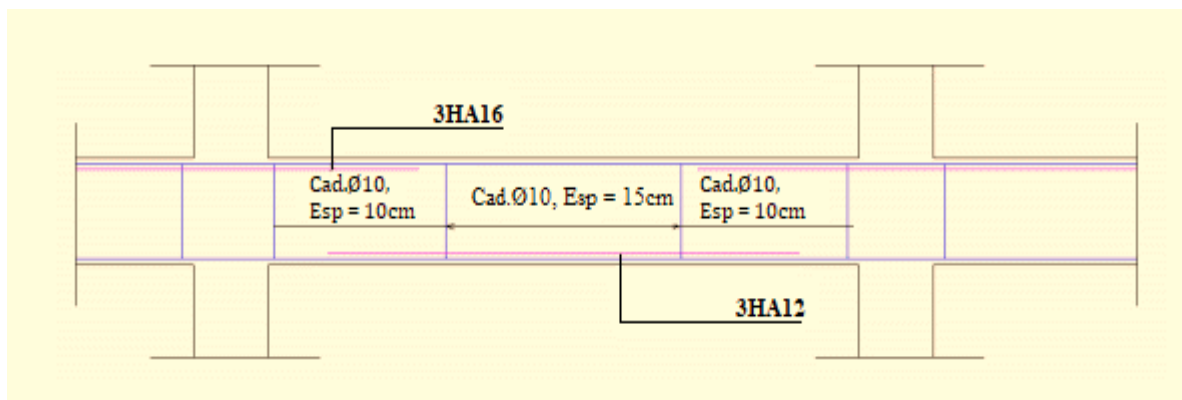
Recouvrement des aciers dans la poutre secondaire au niveau de RDC.
